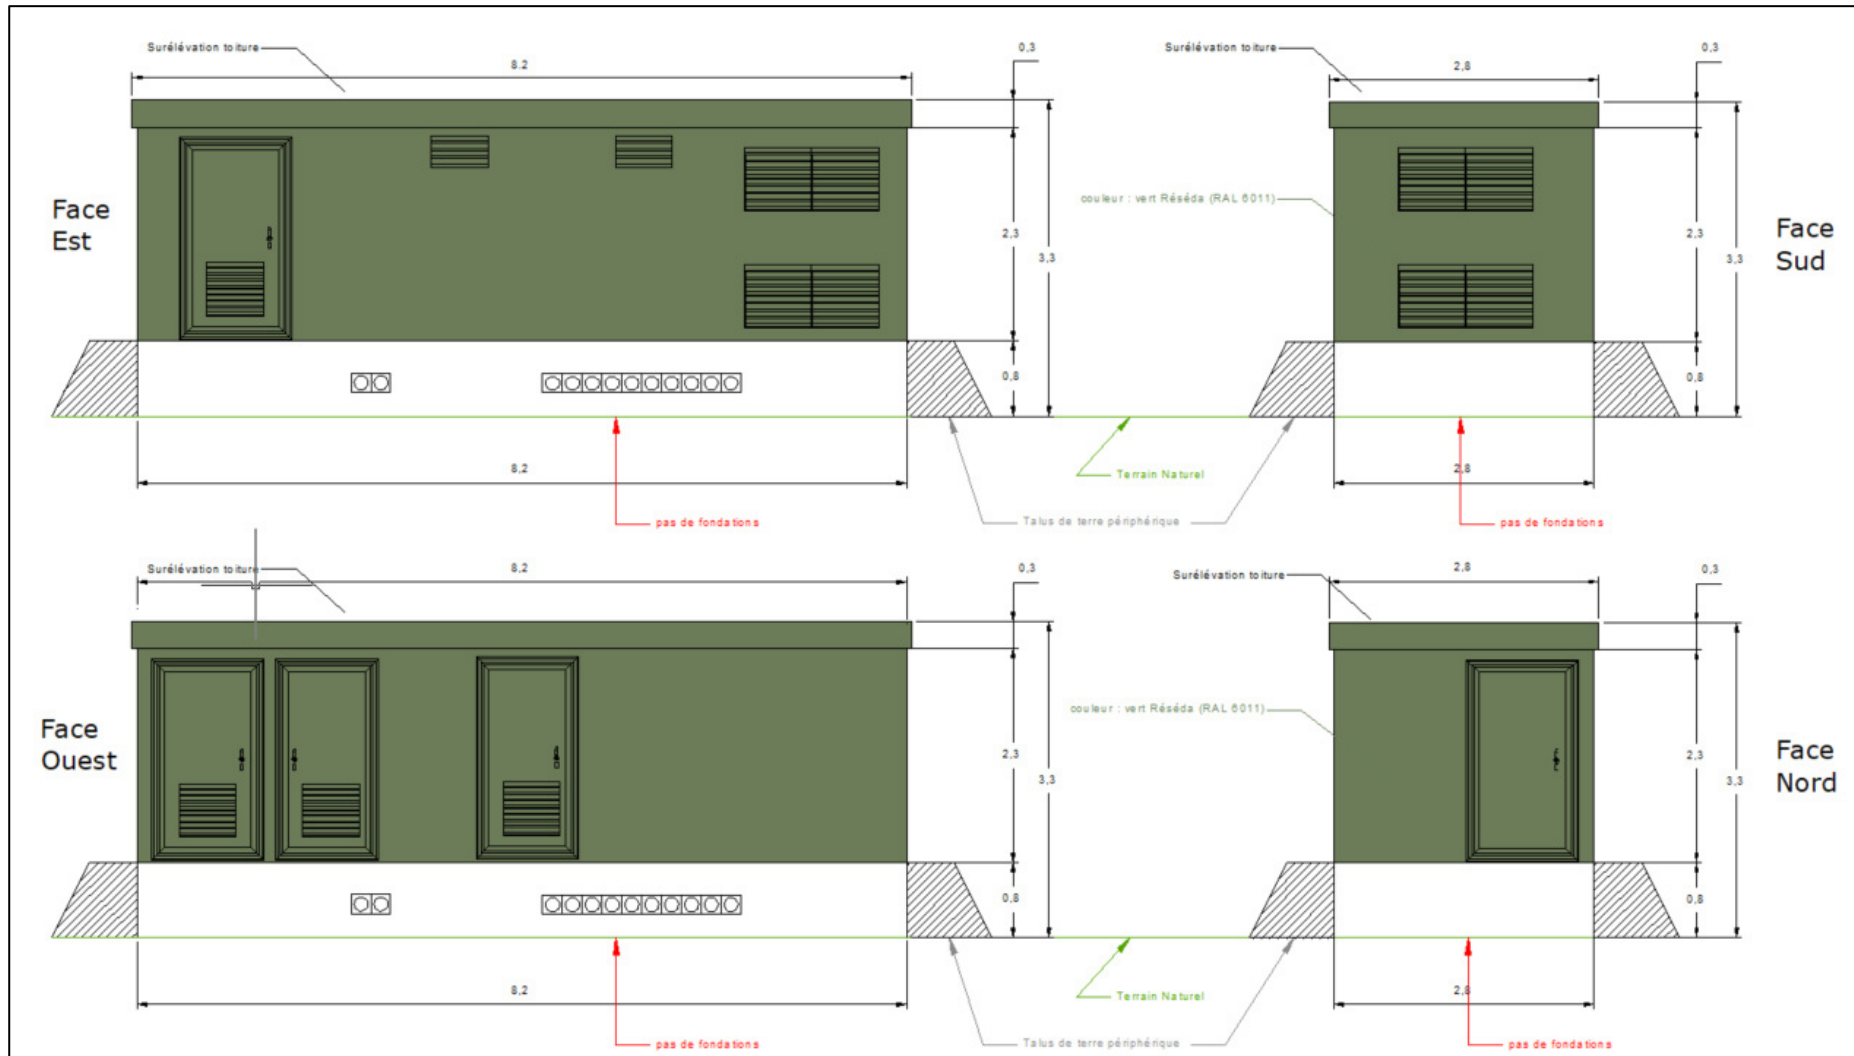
Plan de coupes des postes de transformation (à droite) et de livraison (à gauche)
